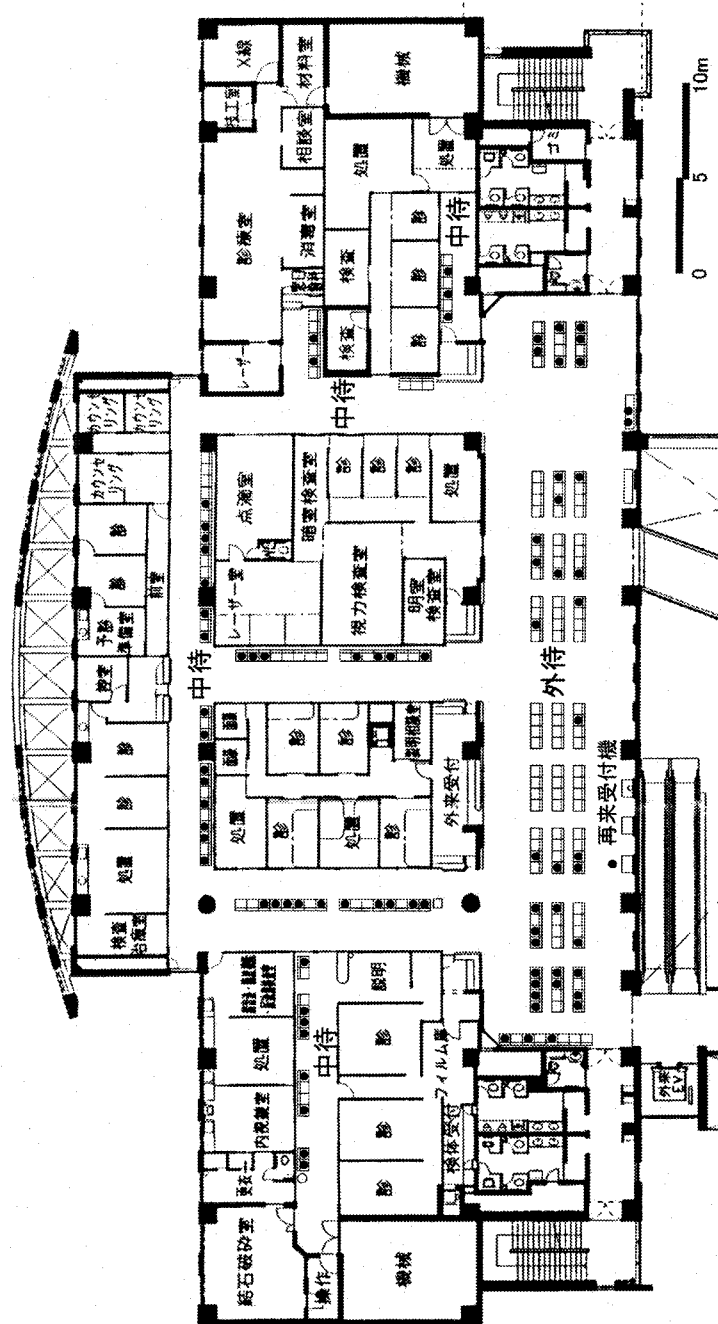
M病院2階外来平面図(2002.10.25 11:00)
